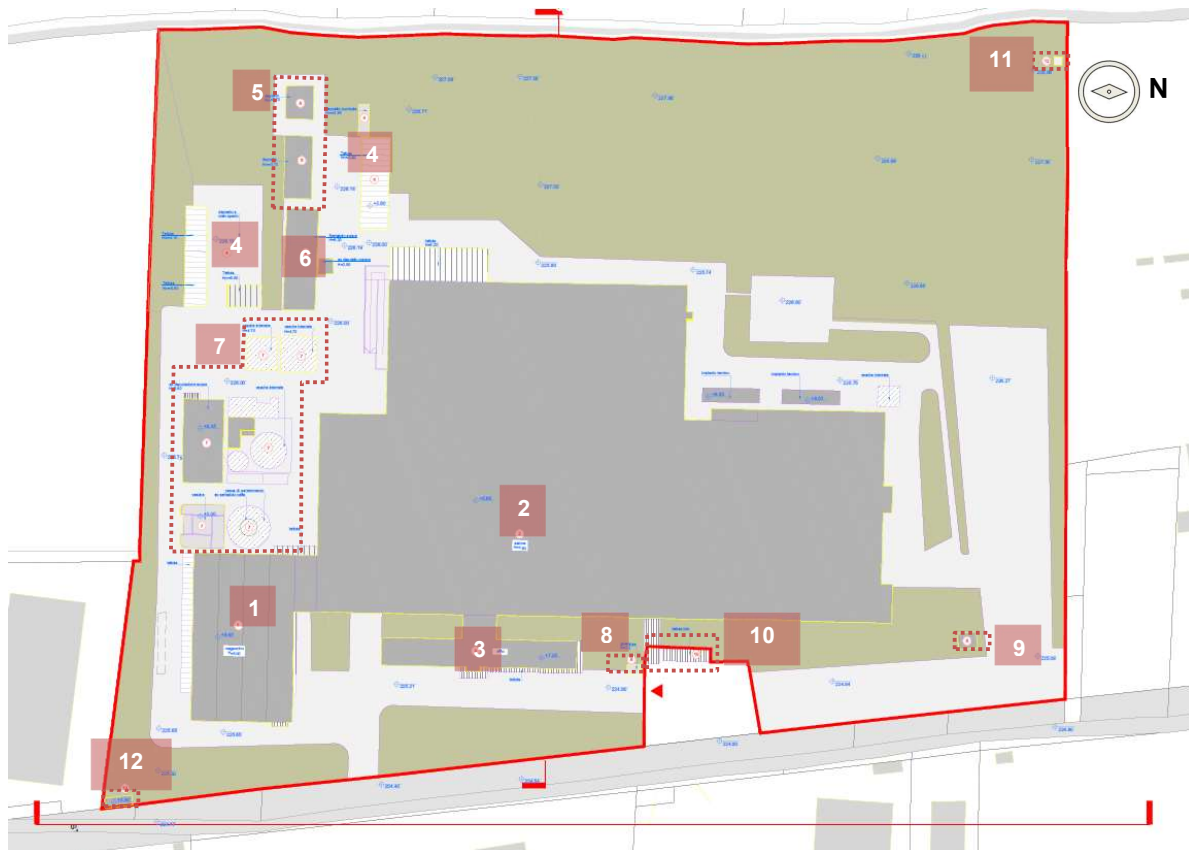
Ubicazione fabbricati/locali/spazi oggetto di demolizione dello stabilimento Ex Zincocelere – Planimetria estratta da documento di riferimento n. 2
